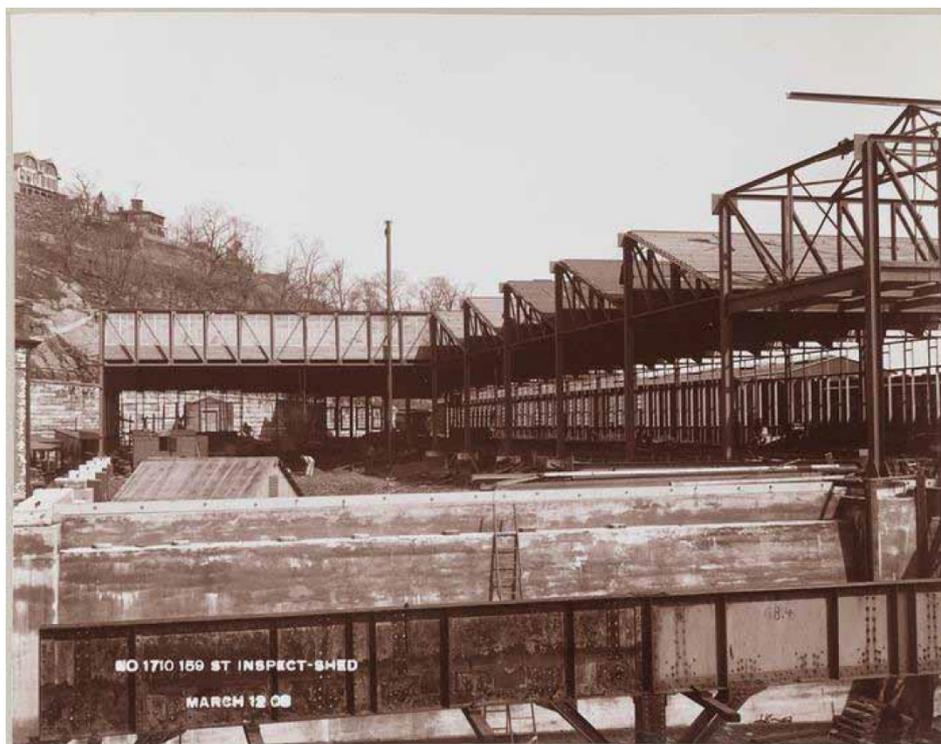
Fotografía de 159th Street Inspection Shed de la Manhattan Railway en 1908. New York. Museo de la ciudad de New York (procedente de Informe: Las Cocheras de Cuatro Caminos)
